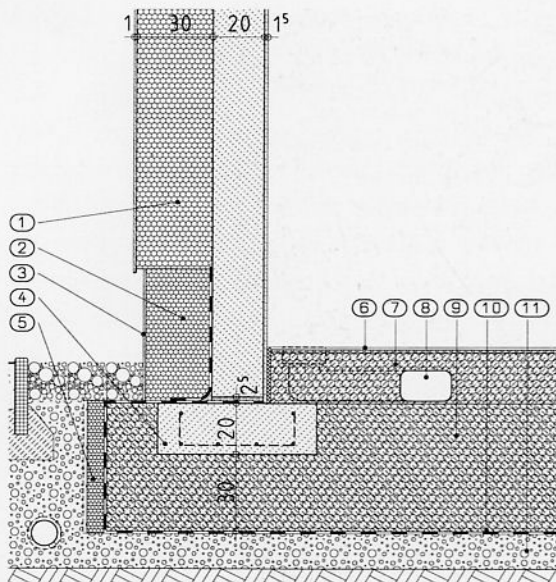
Isolation de la dalle de sol en béton armé monolithique
